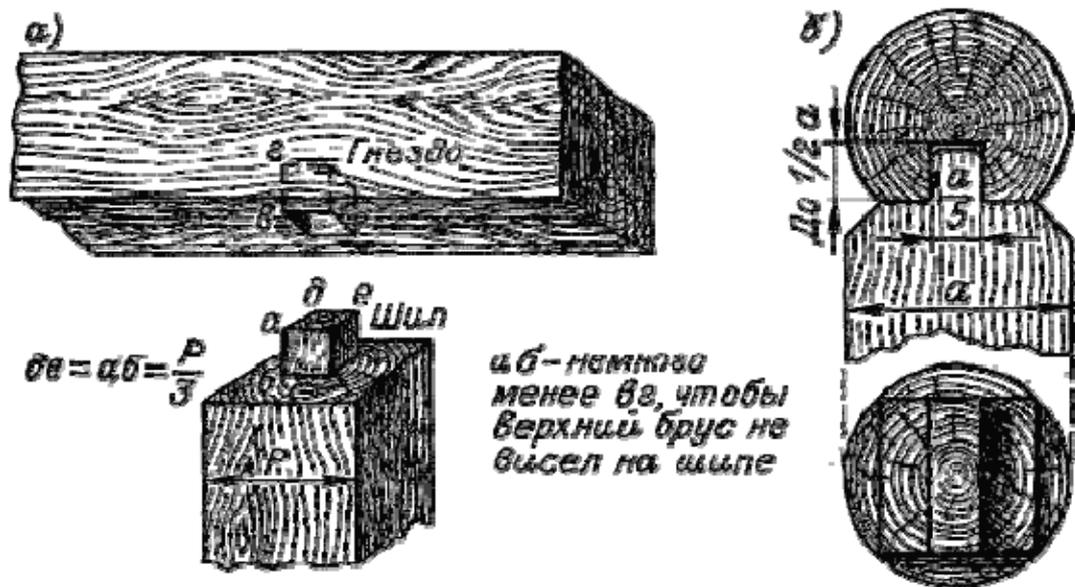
Врубка шипом: а) квадратным; б) продолговатым.
